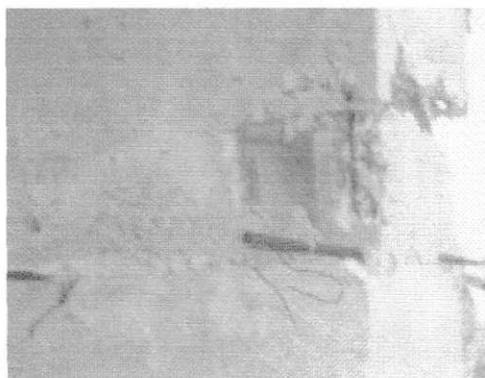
Foto de um dos pilares que apresenta armadura exposta.
